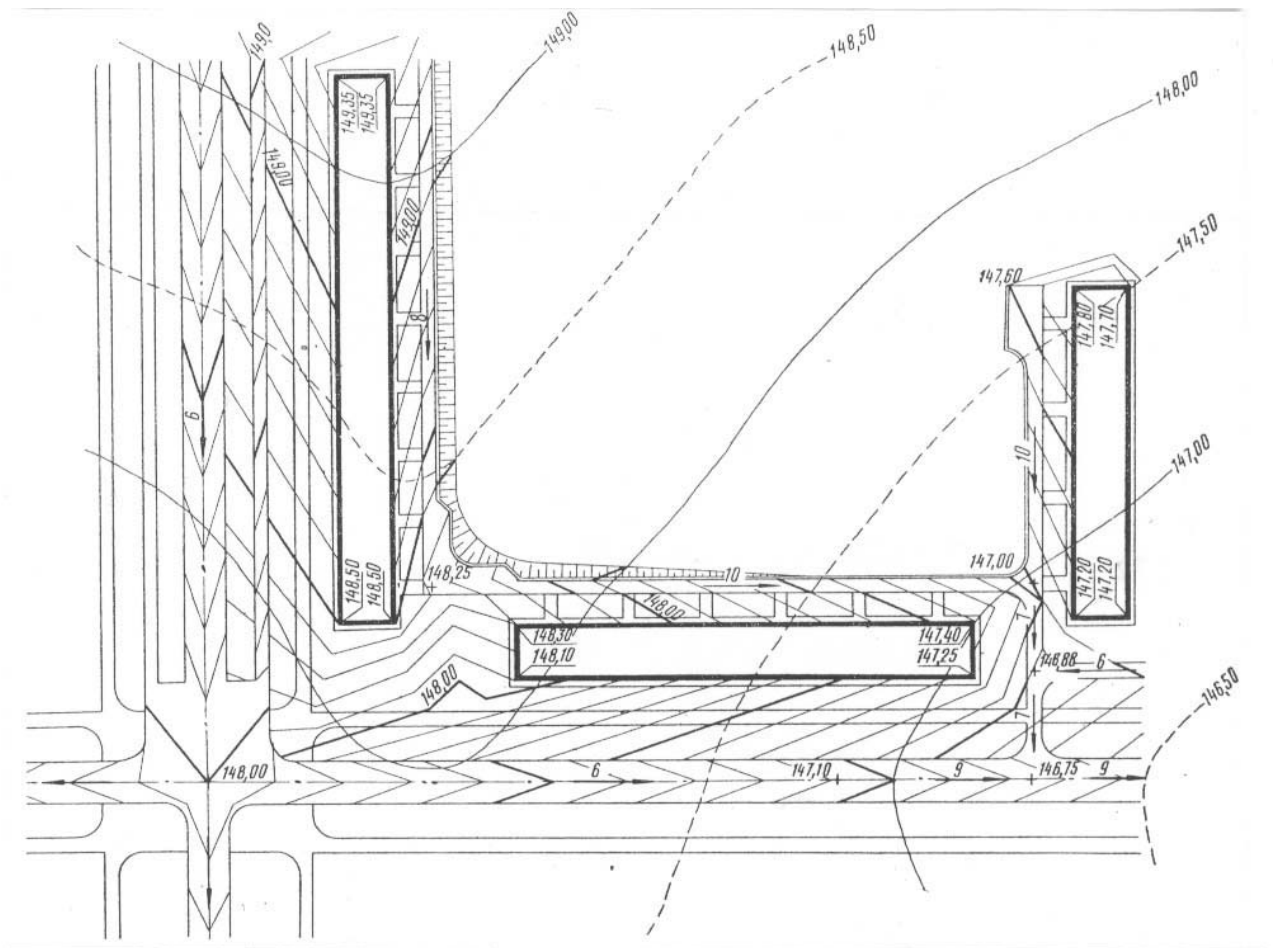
Проектирование вертикальной планировки по проездам, площадкам и зданиям жилого микрорайона.
